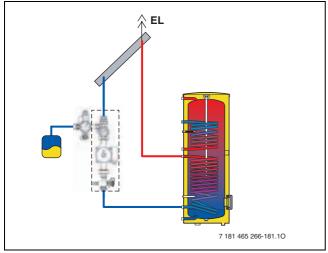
Anschluss-Schema mit 1-Strang-Station und Entlüfter am Dach
